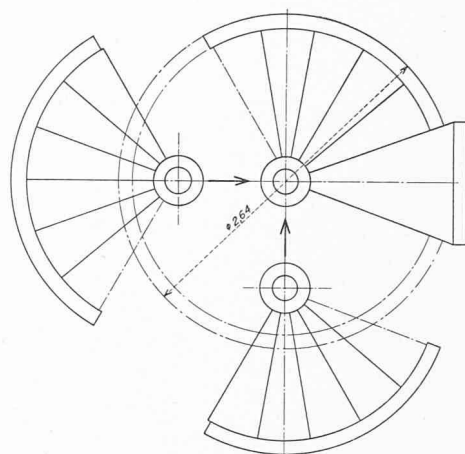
Vue en plan des trois éléments préfabriqués constituant une hauteur d'étage de l'escalier.
